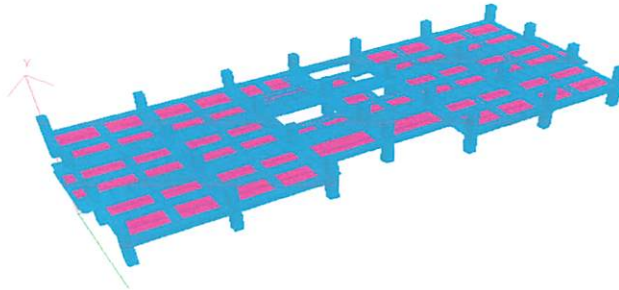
Pemodelan struktur lantai 3 pada STAAD Pro
